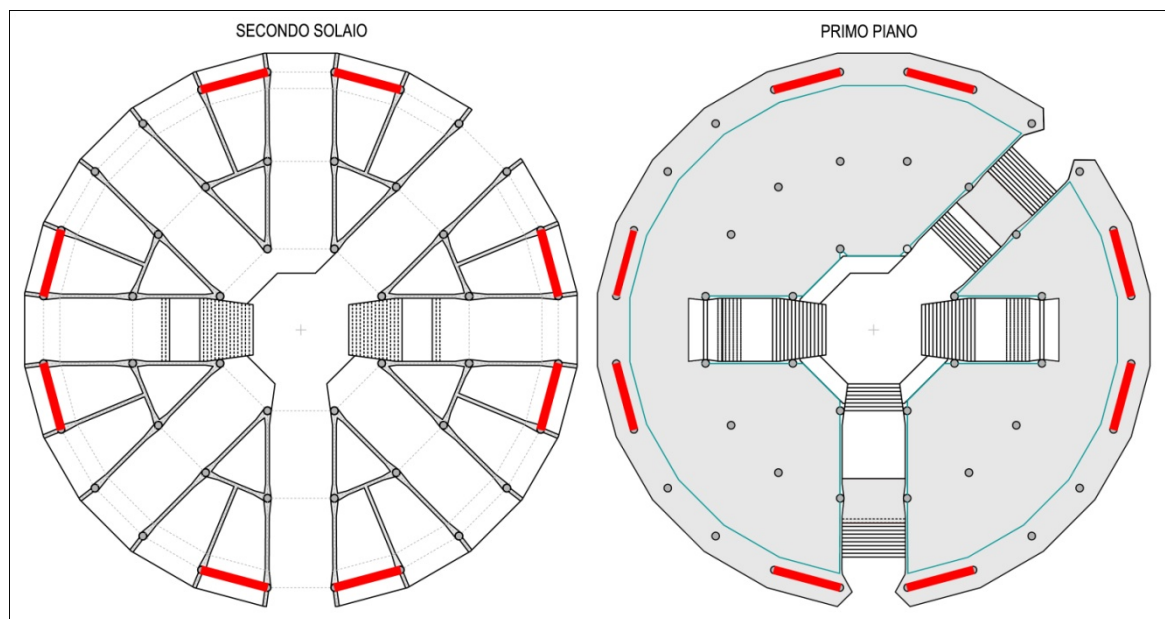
pianta strutturale ed architettonica del secondo solaio con rappresentazione degli interventi
